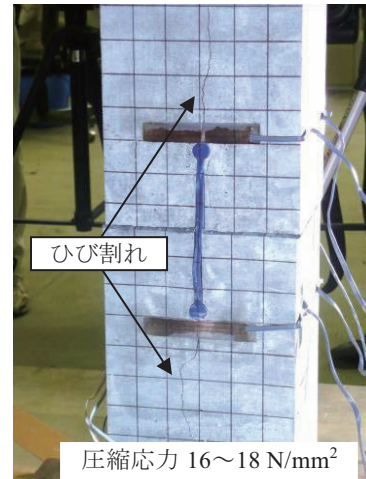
供試体 1 の荷重途中のひび割れ発生状況
